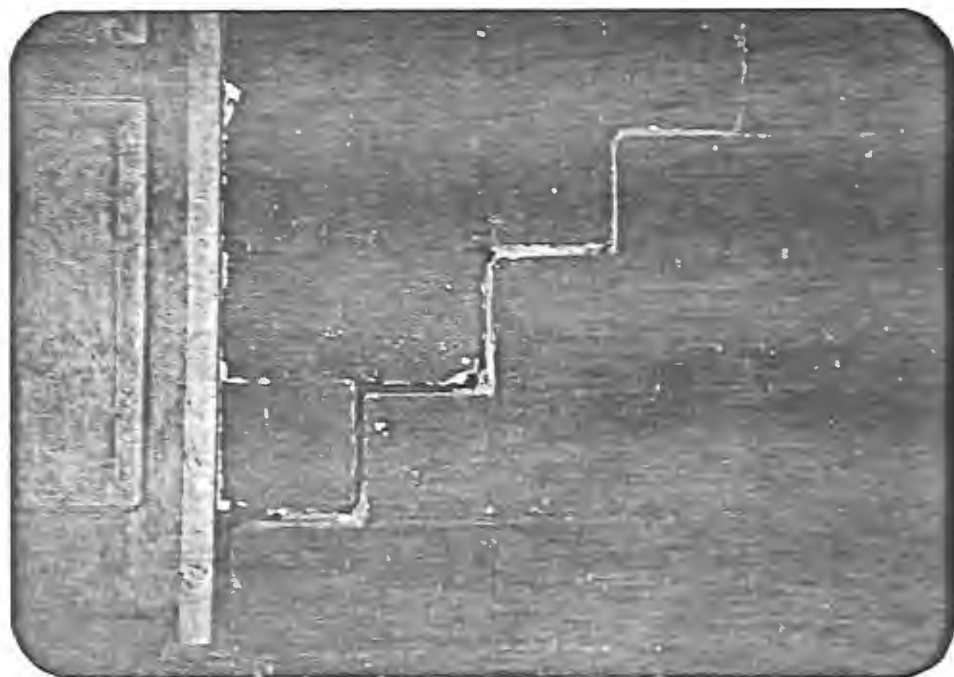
DETALHE DAS RACHADURAS JUNTO ÀS PORTAS.
